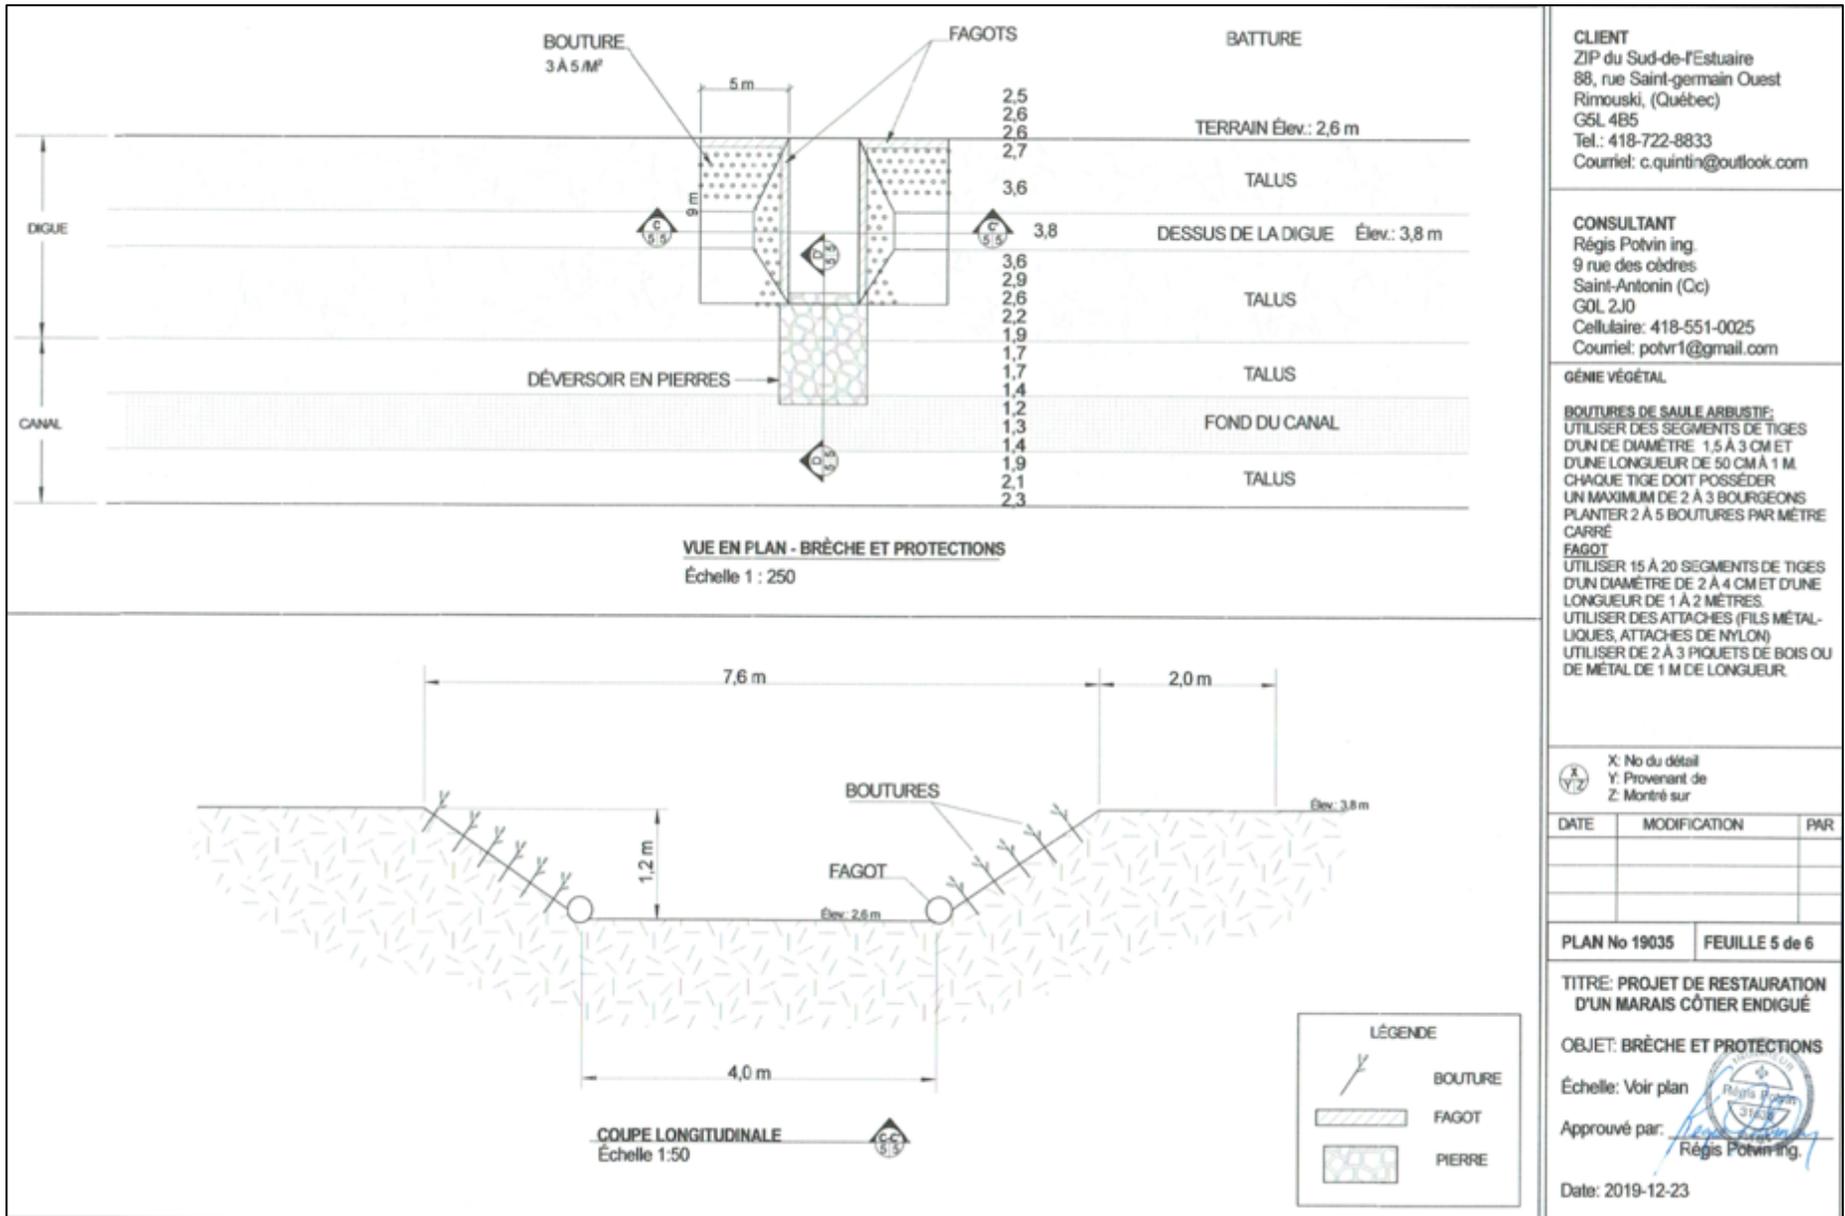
Plan 19 035 feuillet #5 - Vue en plan et coupe longitudinale de l'aménagement de l'ouverture consolidée.
